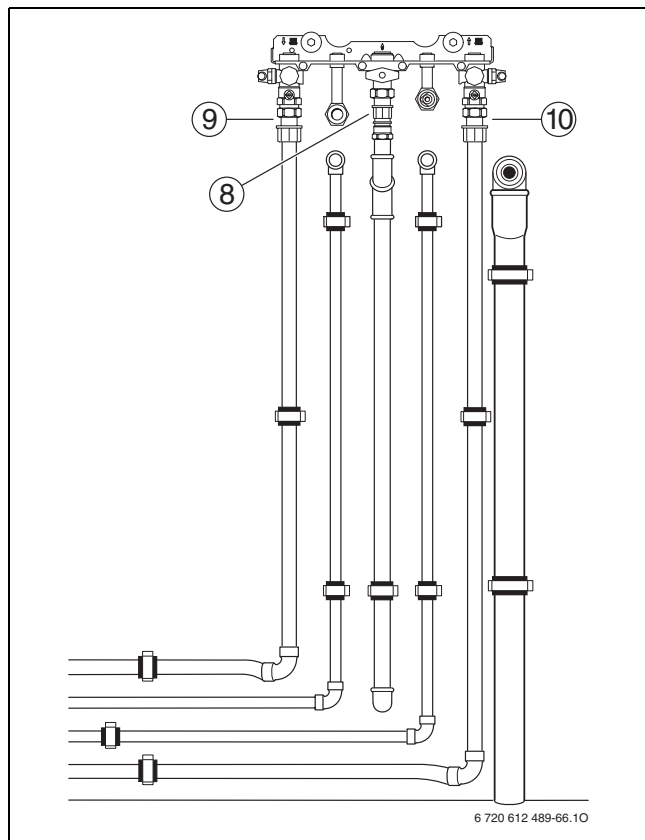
Bauseitige Aufputzverrohrung mit 60 mm Wandabstand
